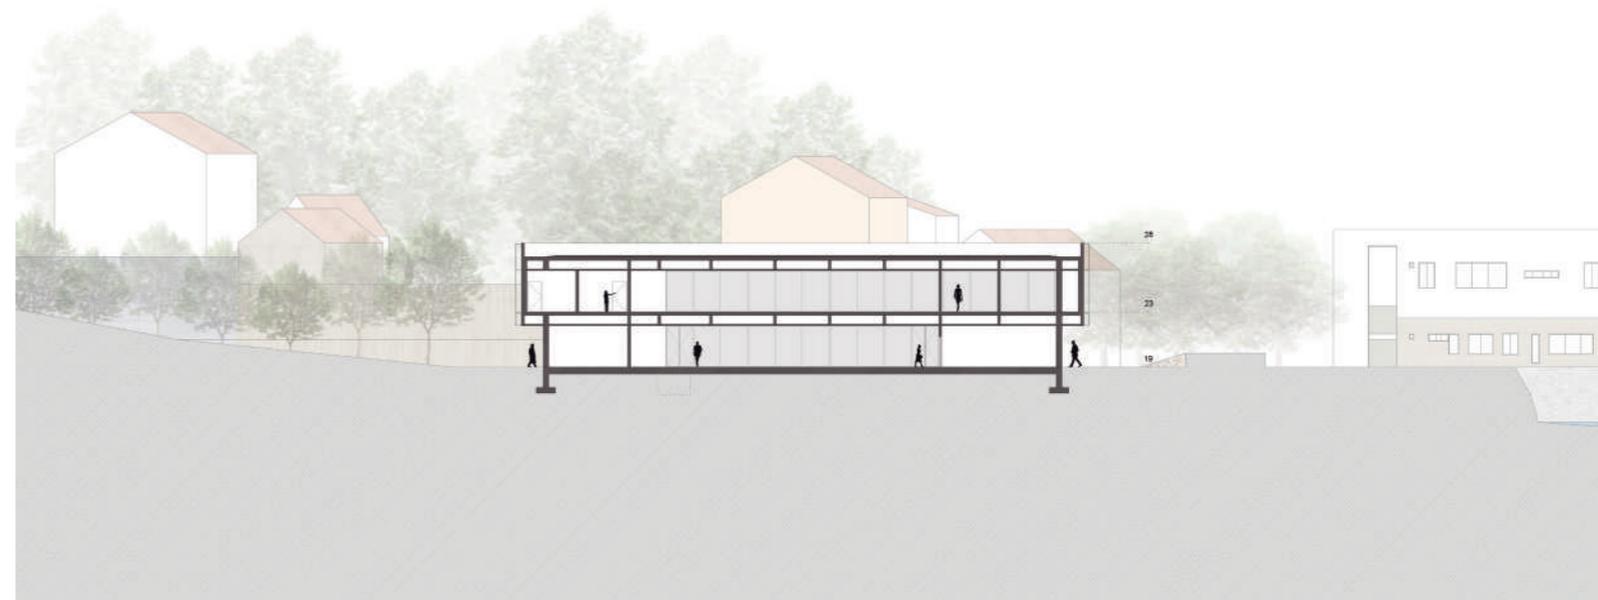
Corte Longitudinal D-D' (redução da escala 1:200)
